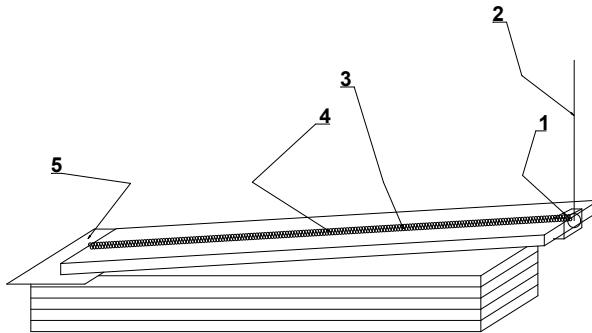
Elementet stiger ur förpackningen stående på hörnet i elementets undre ända.
